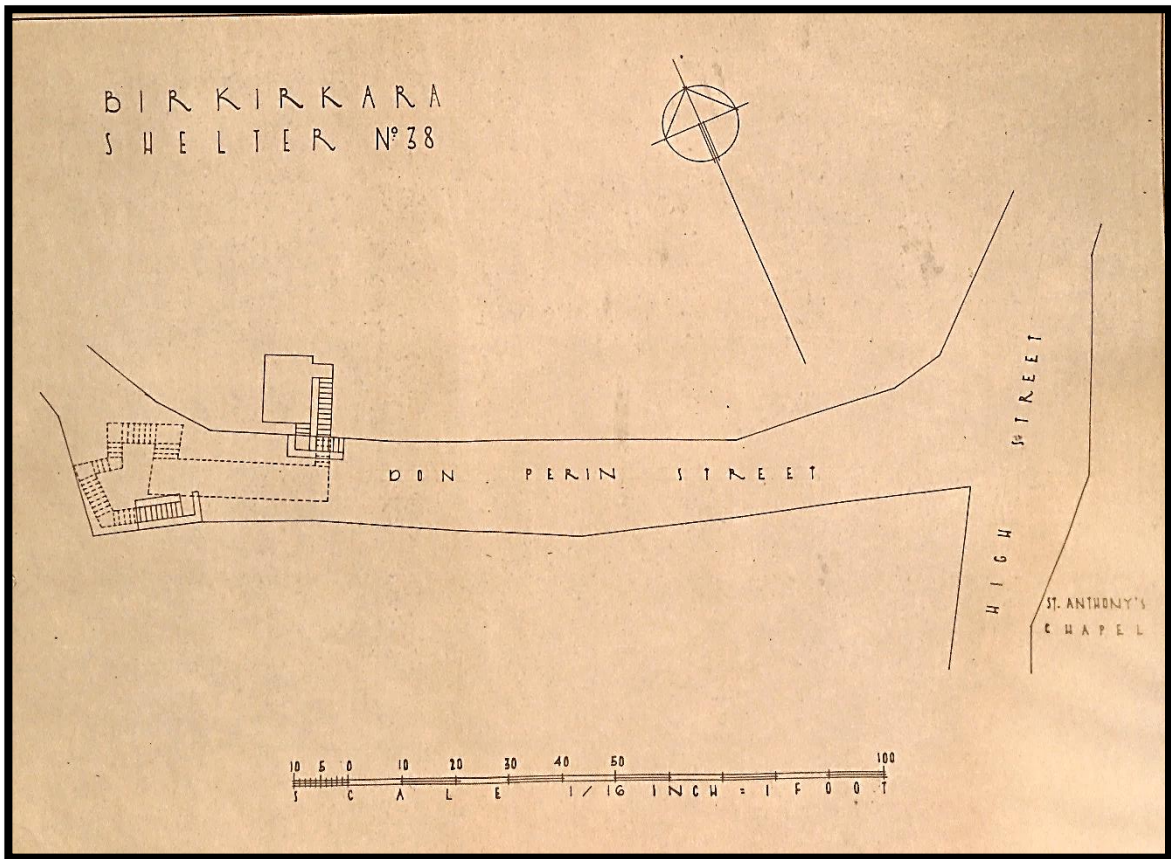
Planta do Abrigo nº 38 "Don Perin Street – High Street."
